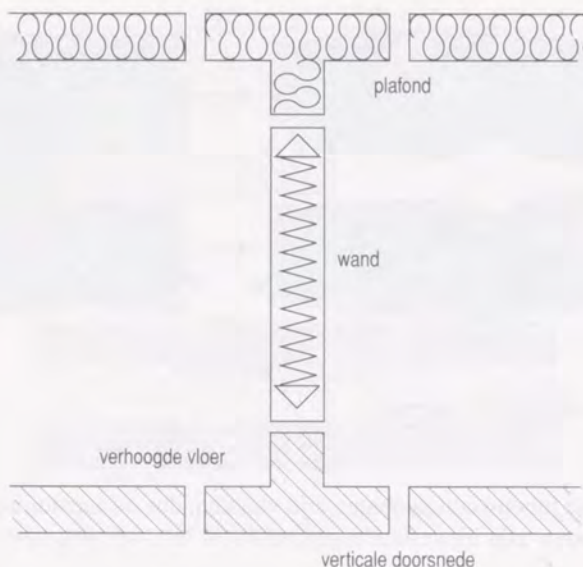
Inwendige veerconstructie voor scheidingswanden
